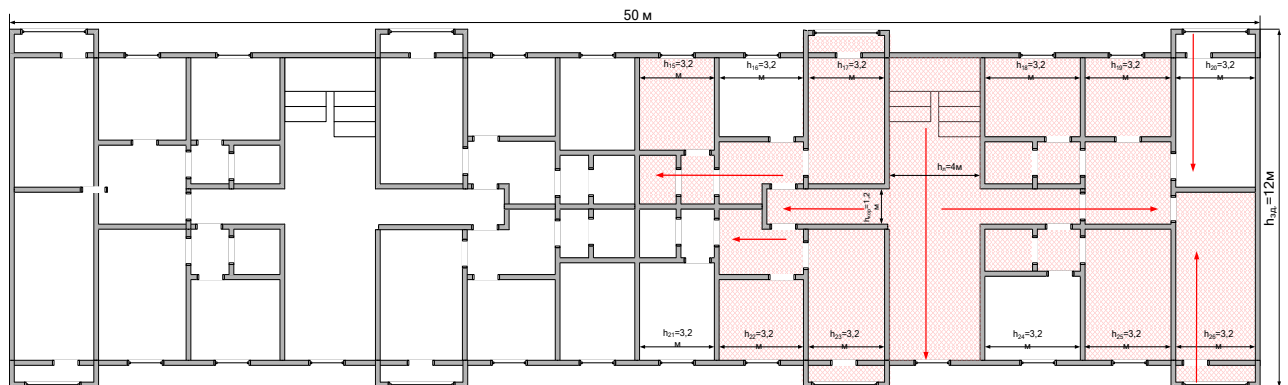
Развитие пожара на момент прибытия РТП-2 на 2-м этаже
